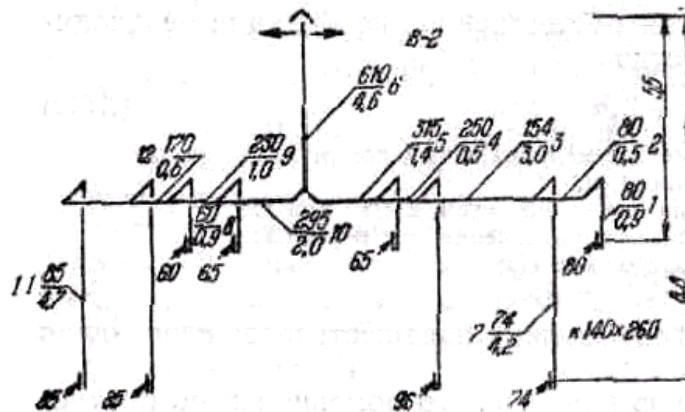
Схема системы вытяжной вентиляции (к примеру расчета воздуховодов).
